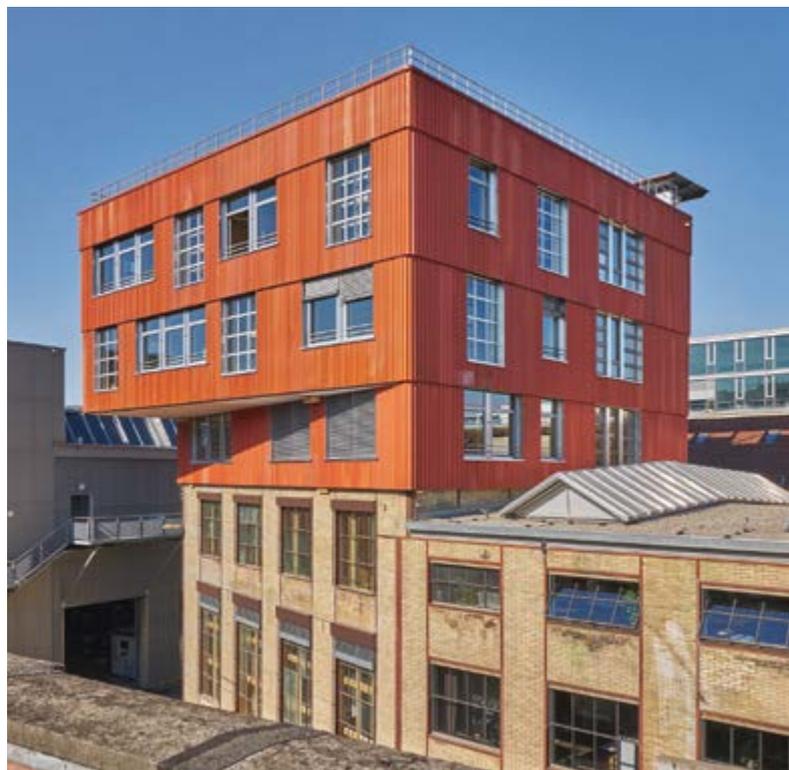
La façade et la structure porteuse de l'extension verticale à trois étages située à l'extrémité du hall 118 sur le site de stockage de Winterthur sont principalement constituées d'éléments de construction de réemploi. (Photo: baubüro in situ/Martin Zeller)
